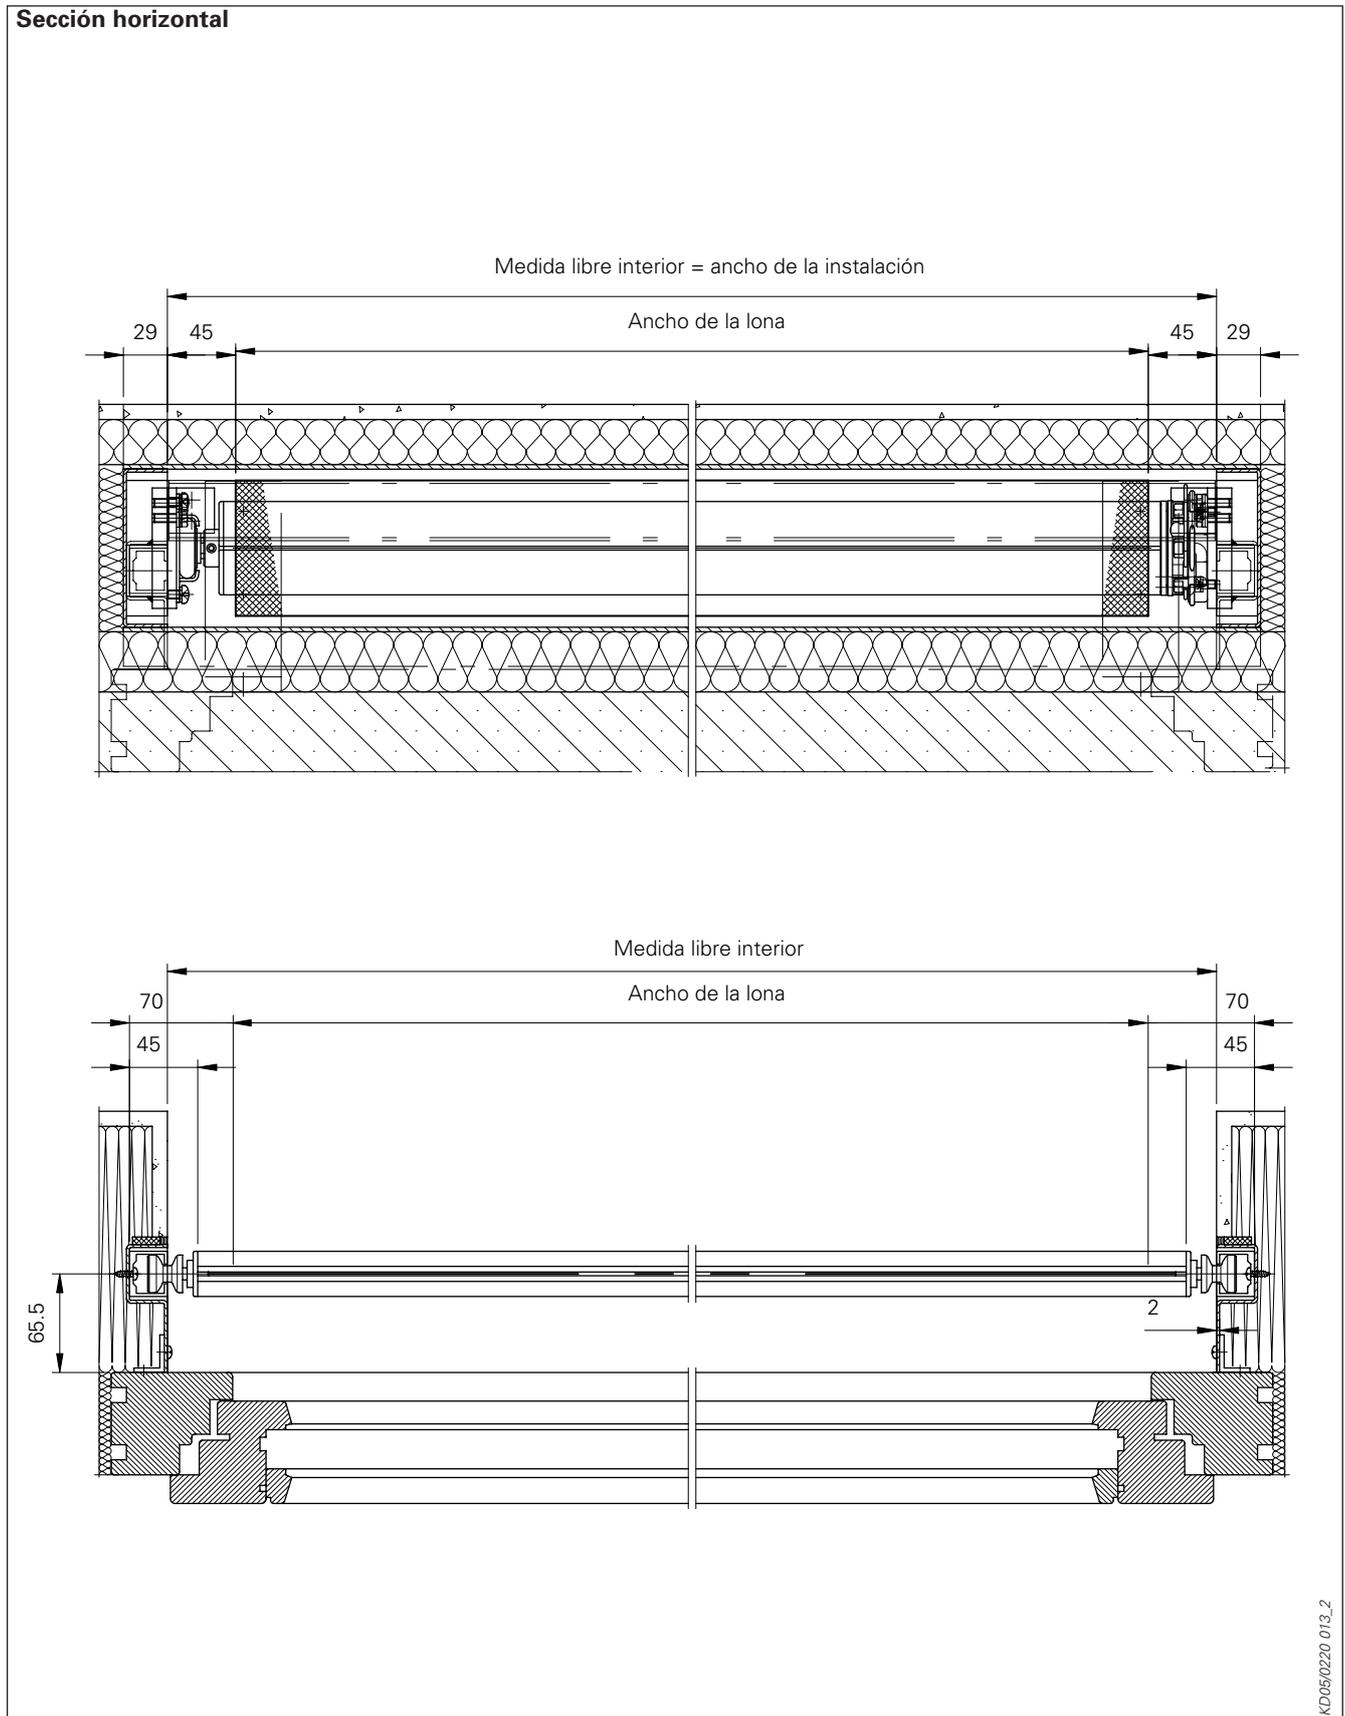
Sección horizontal toldo para fachada Modelo 209 E con carril en C 25/30 empotrado en fachada con aislamiento térmico
